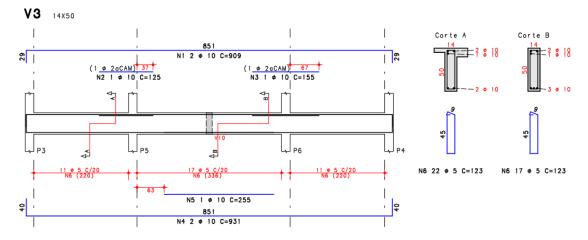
Detalhe da armação de uma viga em concreto armado.
